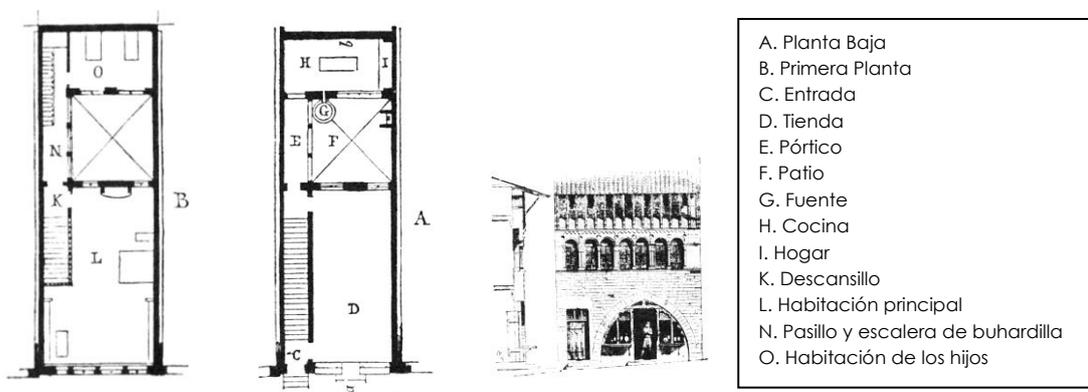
3. Alzado y planta baja y primera de una casa típica de Cluny, Francia
